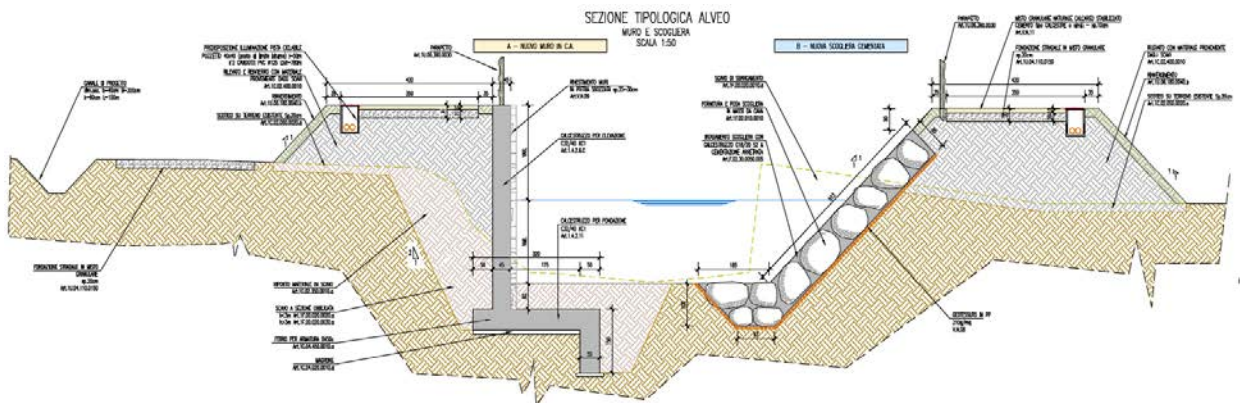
Estratto Tavola 17. Sezioni tipologiche e particolari. Dettaglio dell'intervento A – Nuovo muro in calcestruzzo armato e B – Nuova scogliera cementata.
